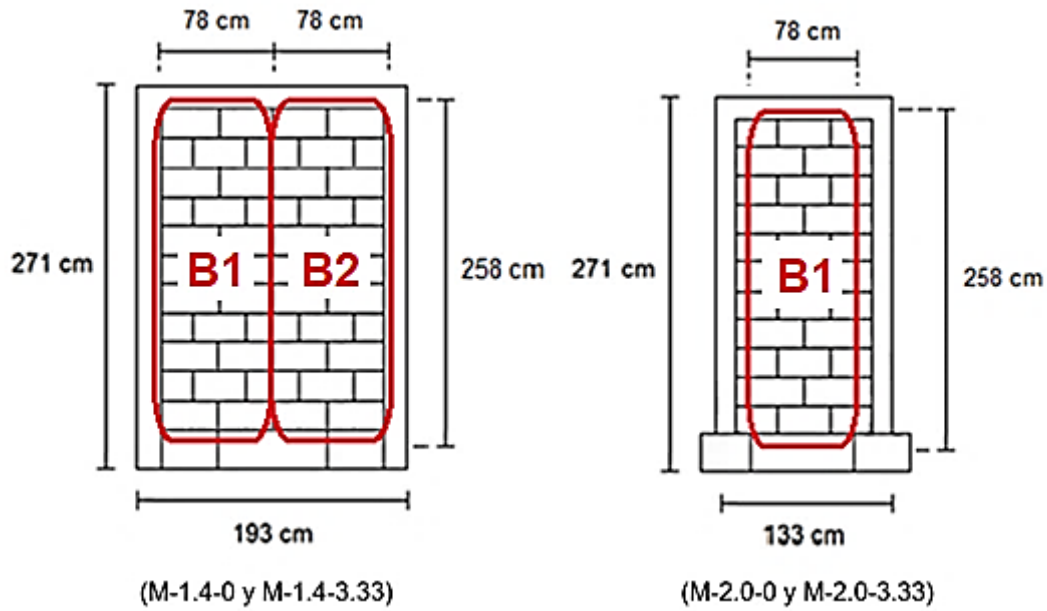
Ubicación de las bolsas de aire en los muros de mampostería confinada.
